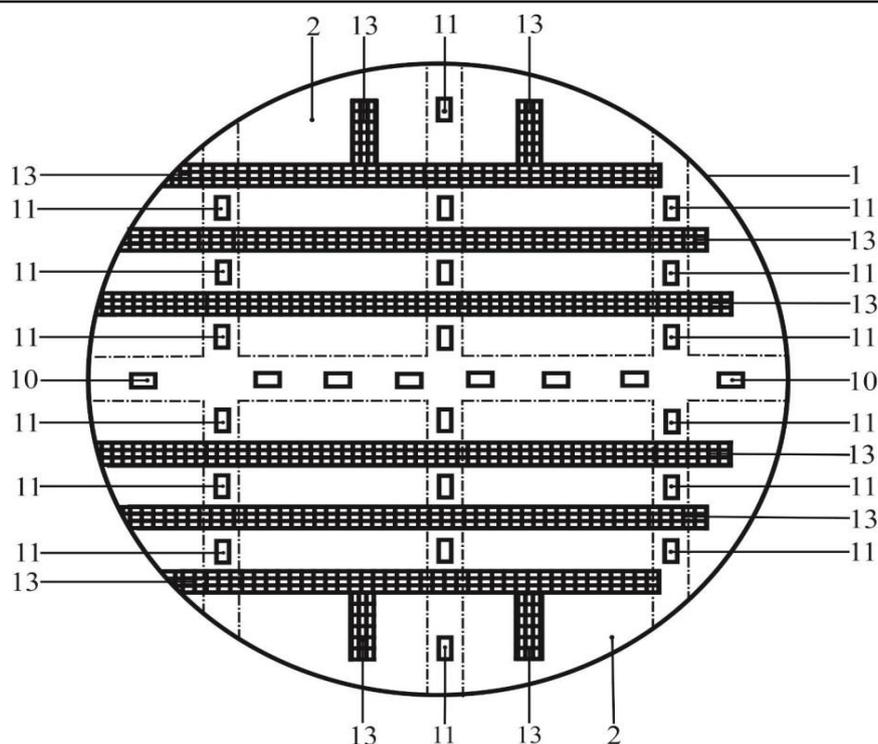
Фундамент цилиндрического бункера для хранения сельскохозяйственной продукции: вид сверху
